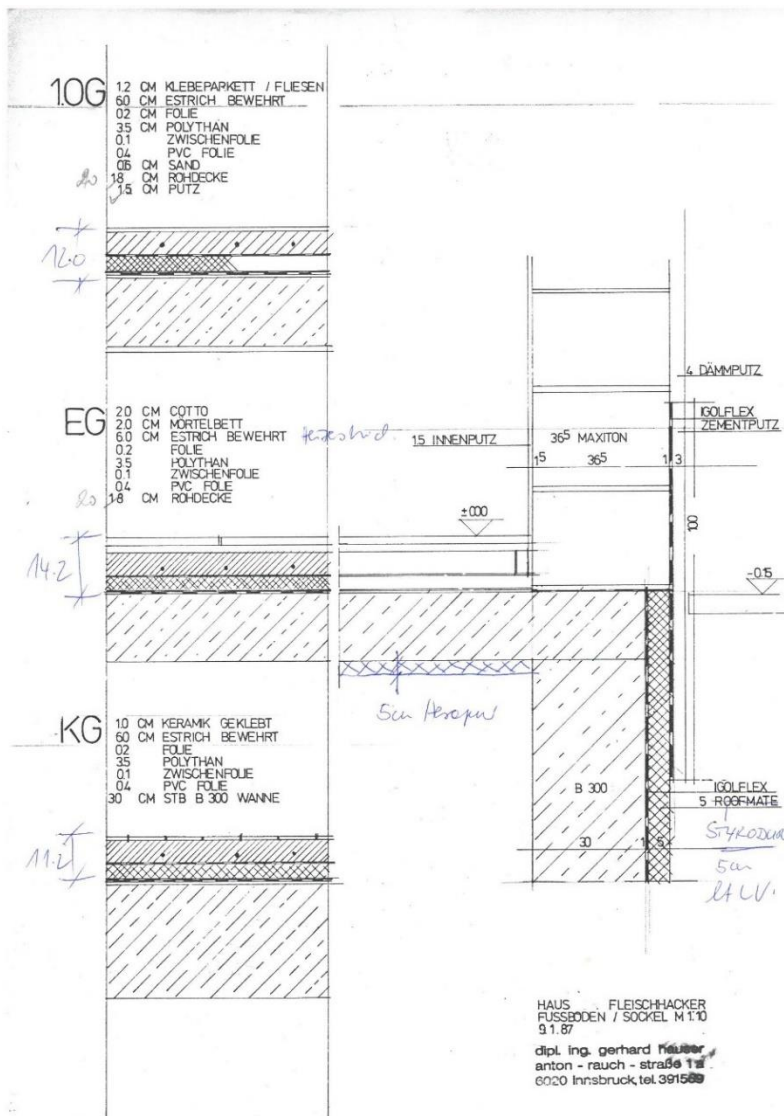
Planunterlage der Fußbodenaufbauten des Bestandsgebäudes
